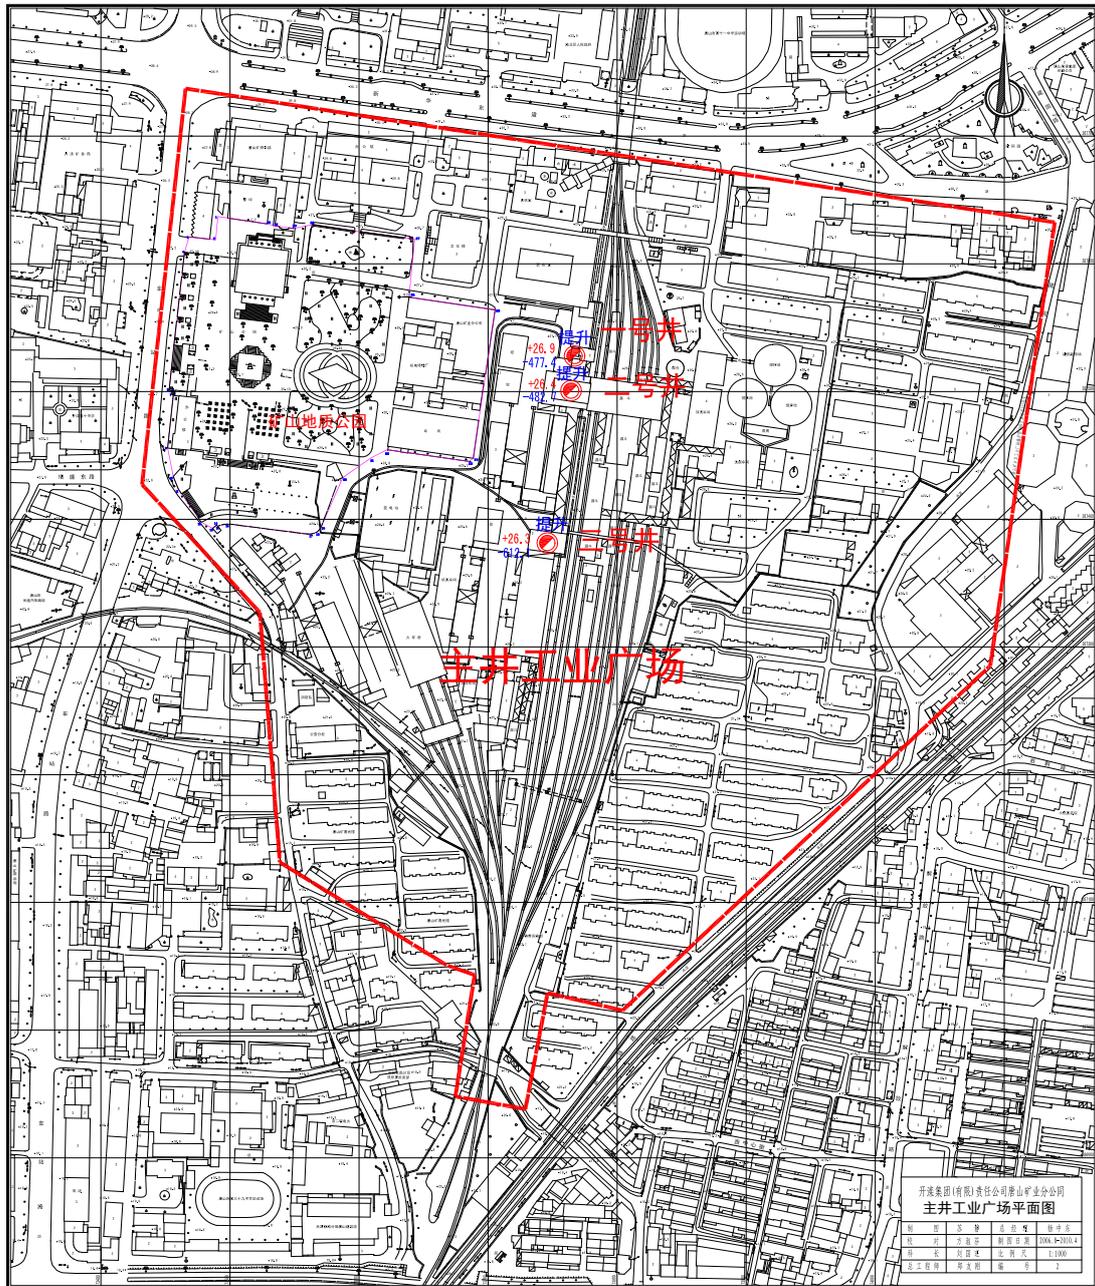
唐山矿主工业广场 (A 工业广场) 平面布置图
